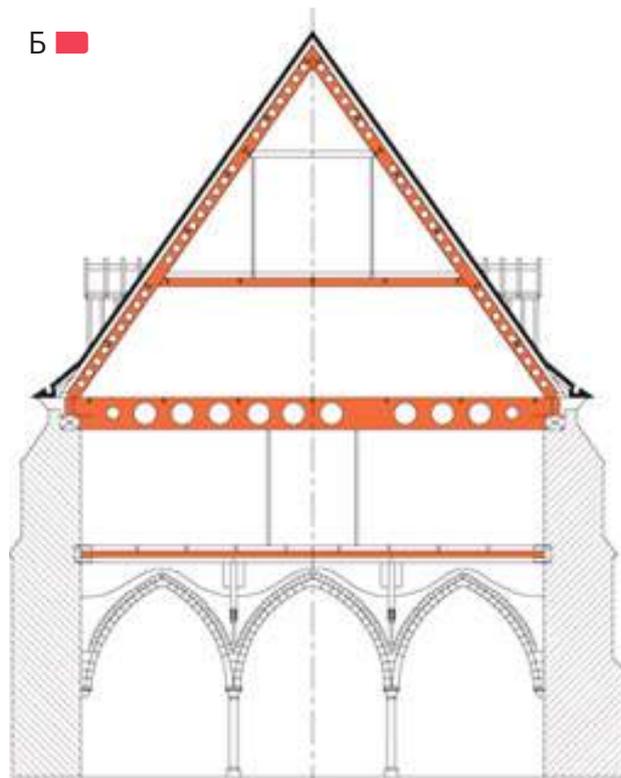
Замена шатра кровли в церкви 16 века с устройством подвесных этажей на перфорированных балках, Великобритания, 2005 г.
